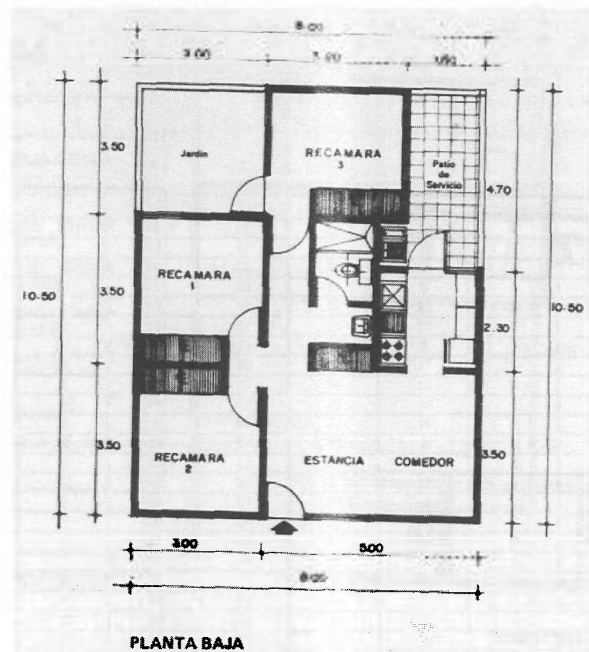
Propuesta arquitectónica tipo 3[1]
